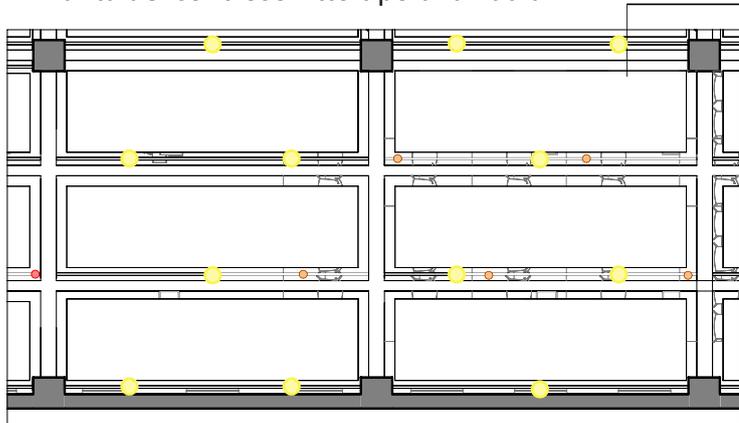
ESTRATTO SDP PIANTA DEL CONTROSOFFITTO
